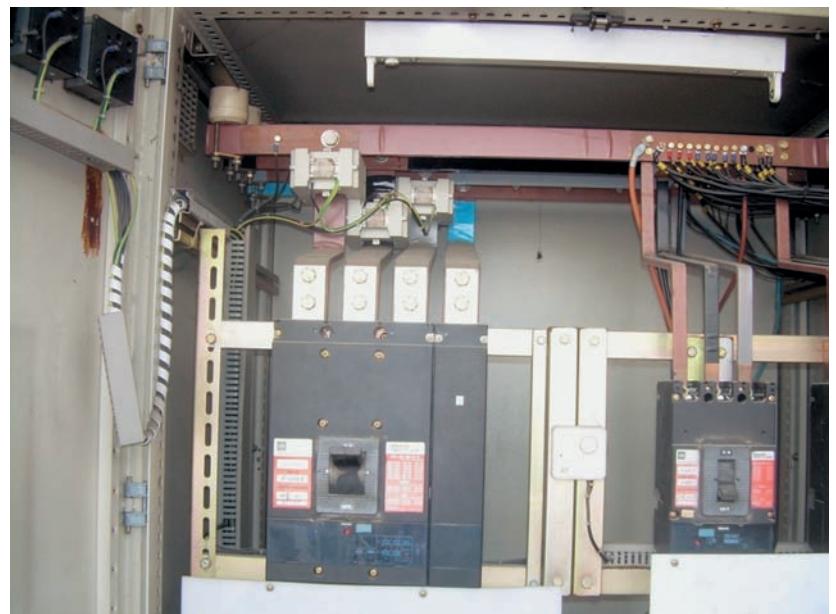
Detalle de conexiones eléctricas en un Centro Docente.
